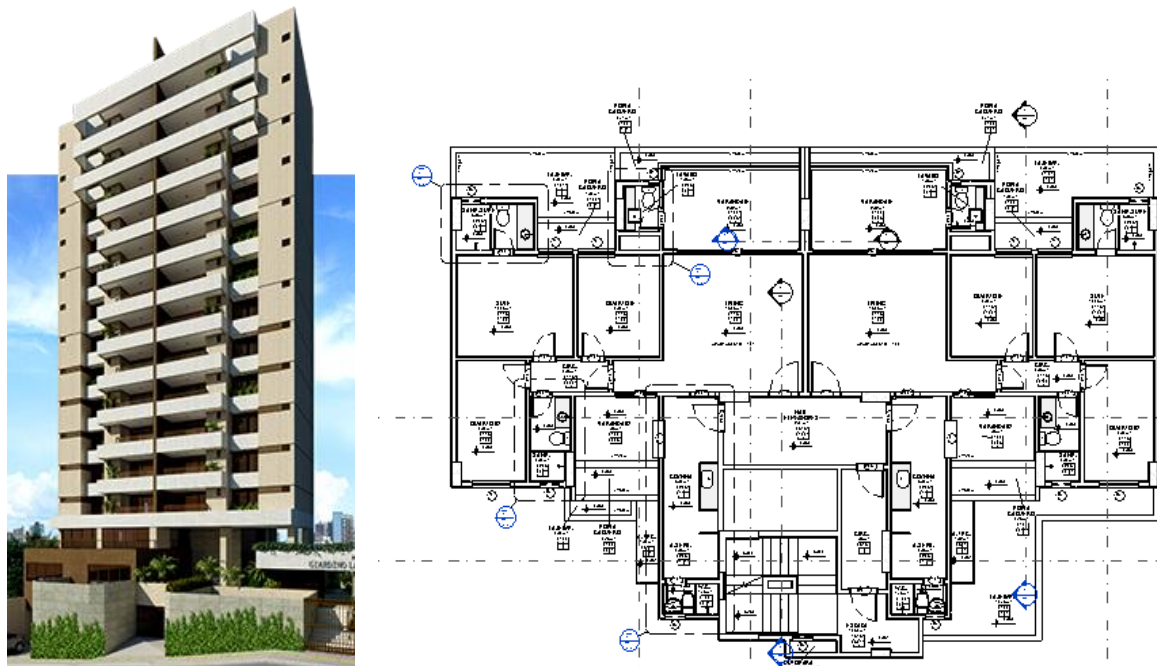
Imagem e planta baixa do projeto. Fonte: Construtora.
